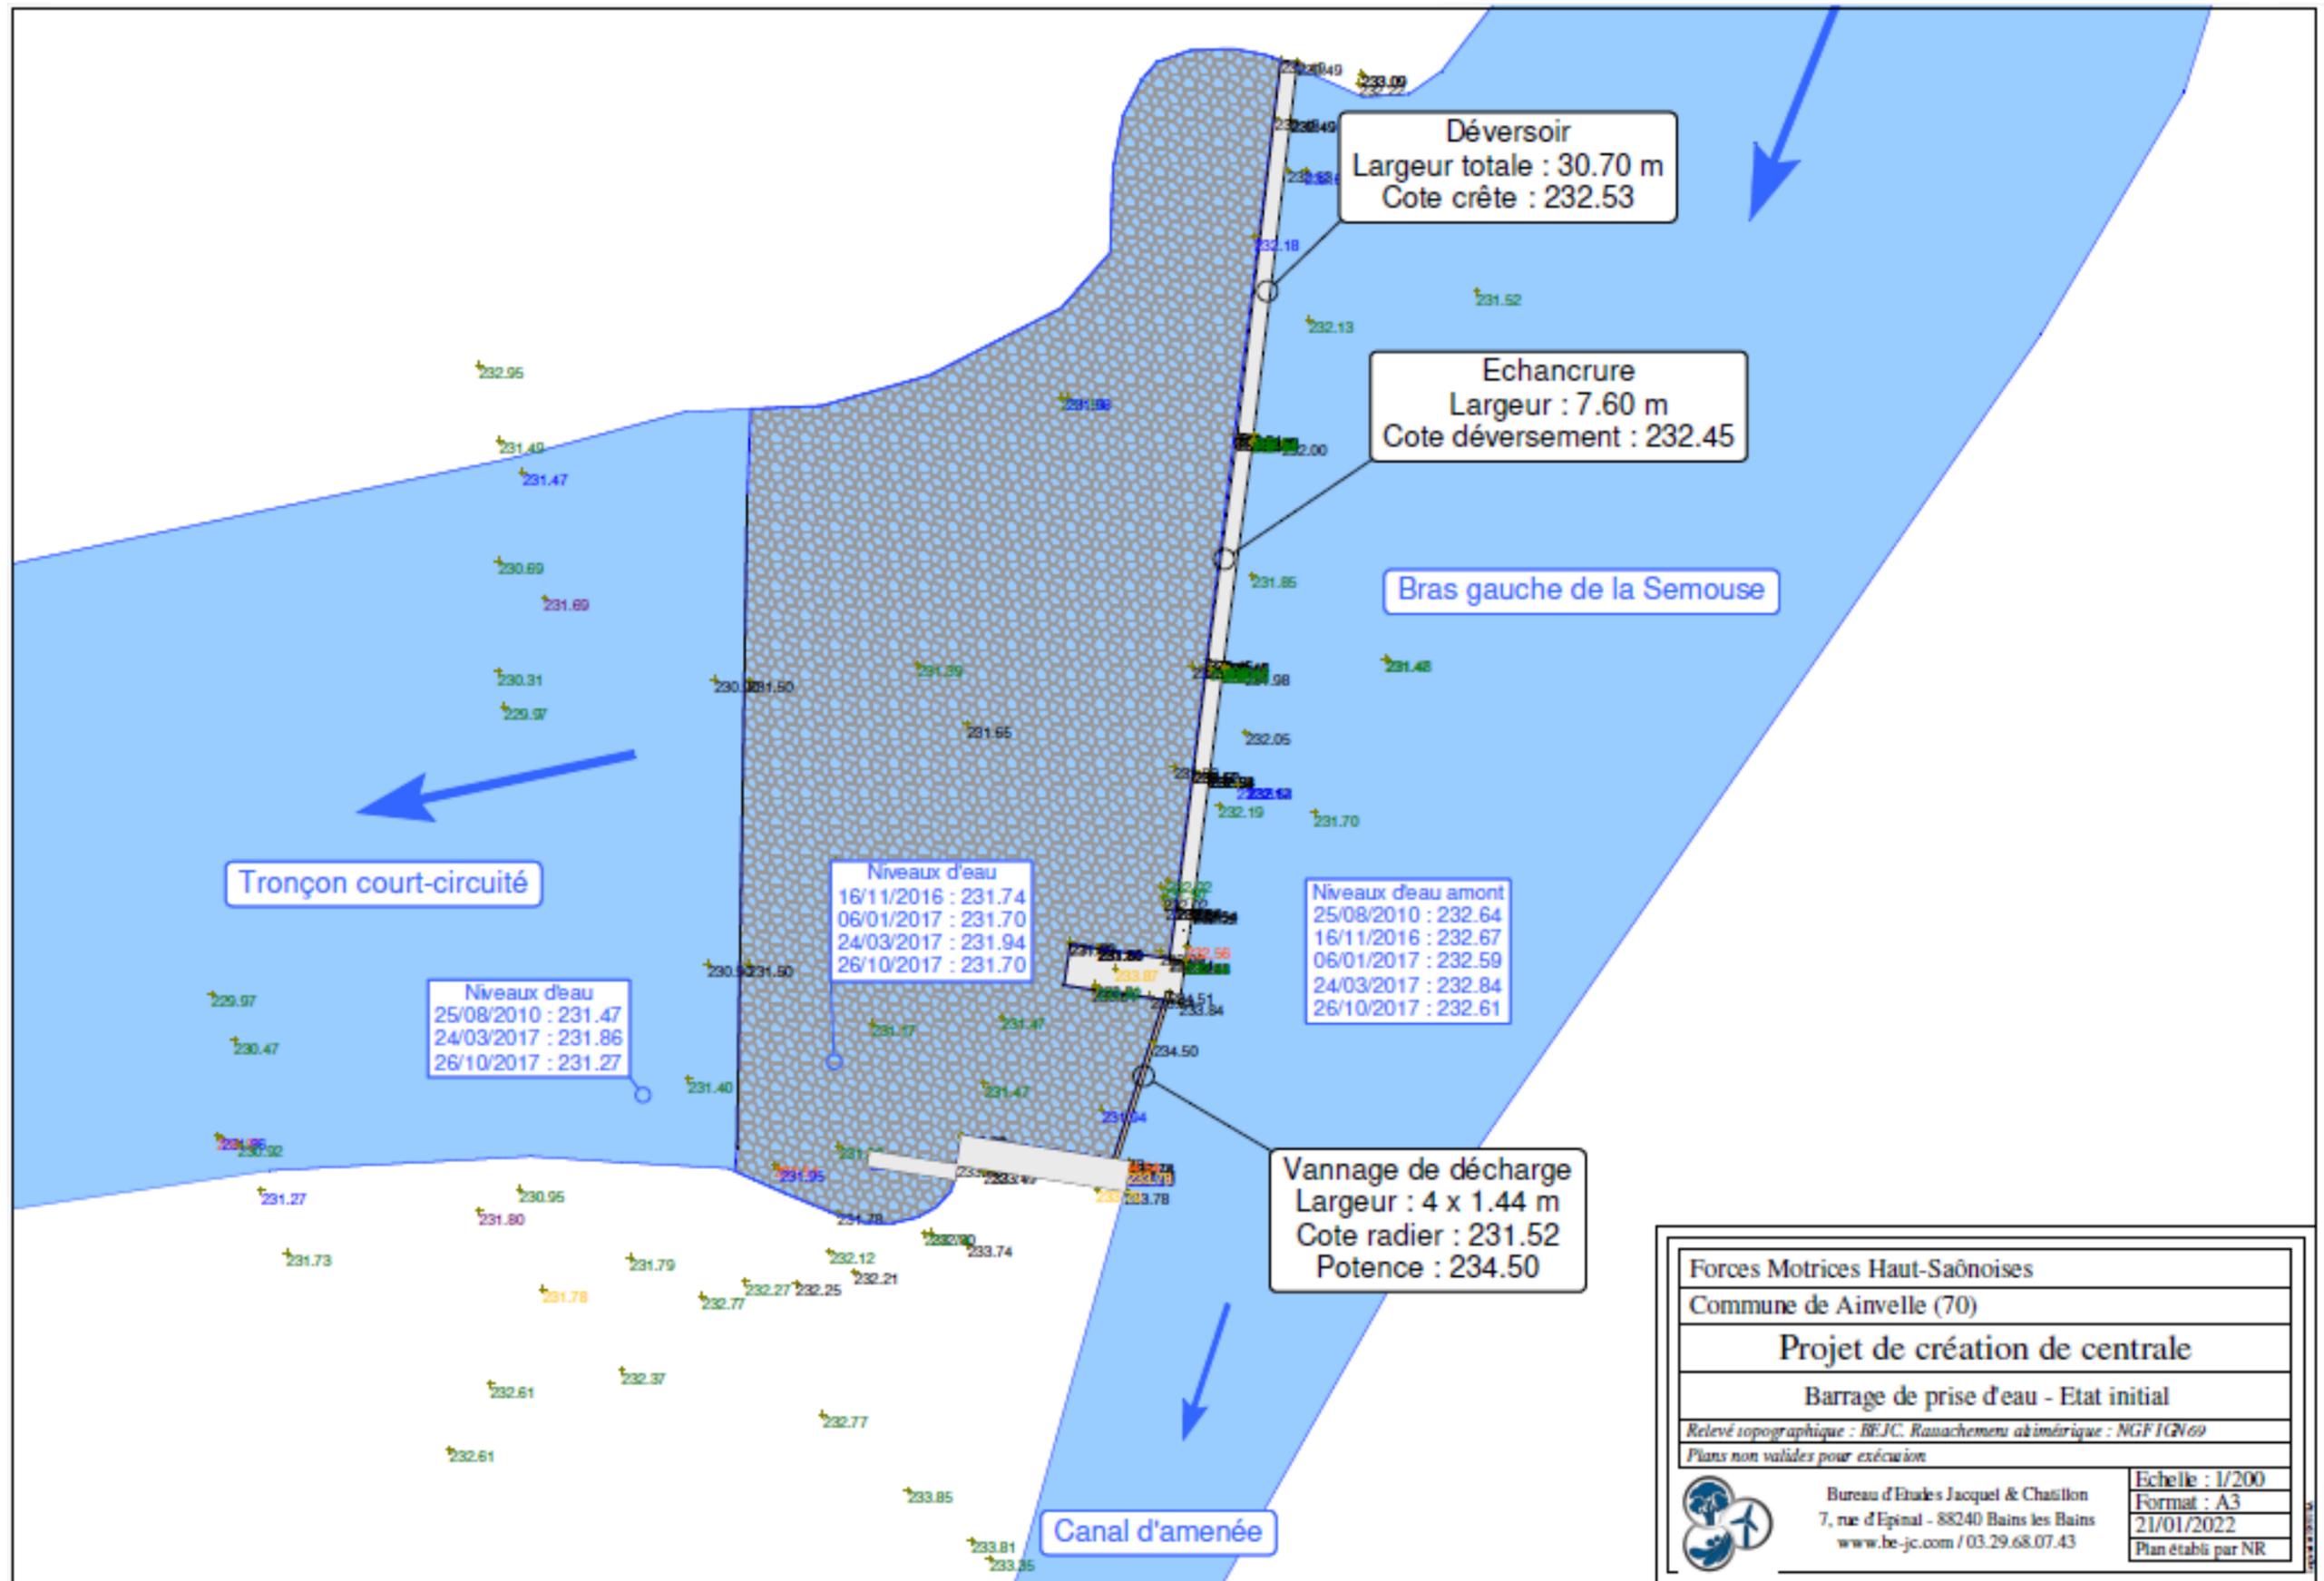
Plan du barrage – Etat initial (Source : BE Jacquet & Chatillon)
